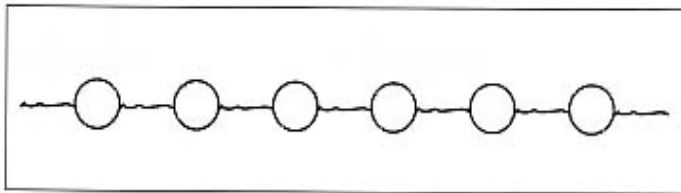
Fisuras debidas al asentamiento plástico del hormigón.
